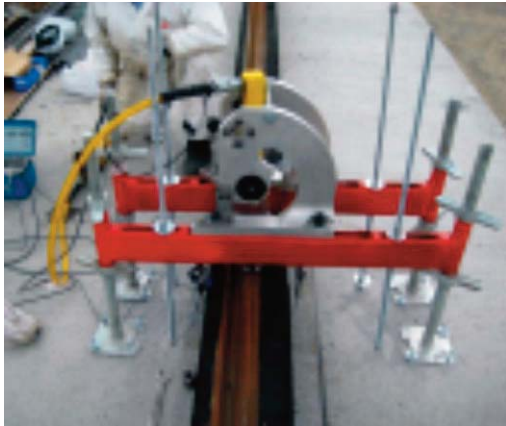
Auscultación de los carriles in situ previa al hormigonado
